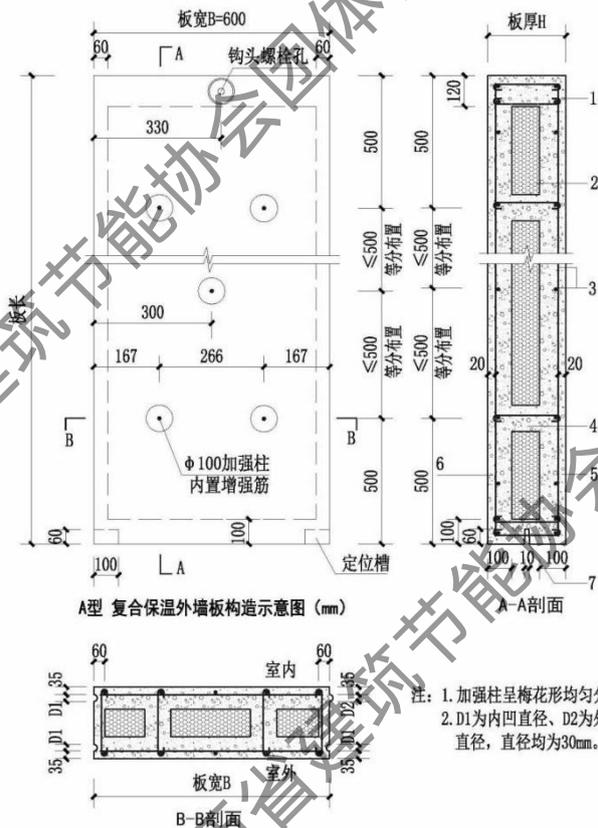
A 型复合保温外墙板基本构造示意图 (mm)
